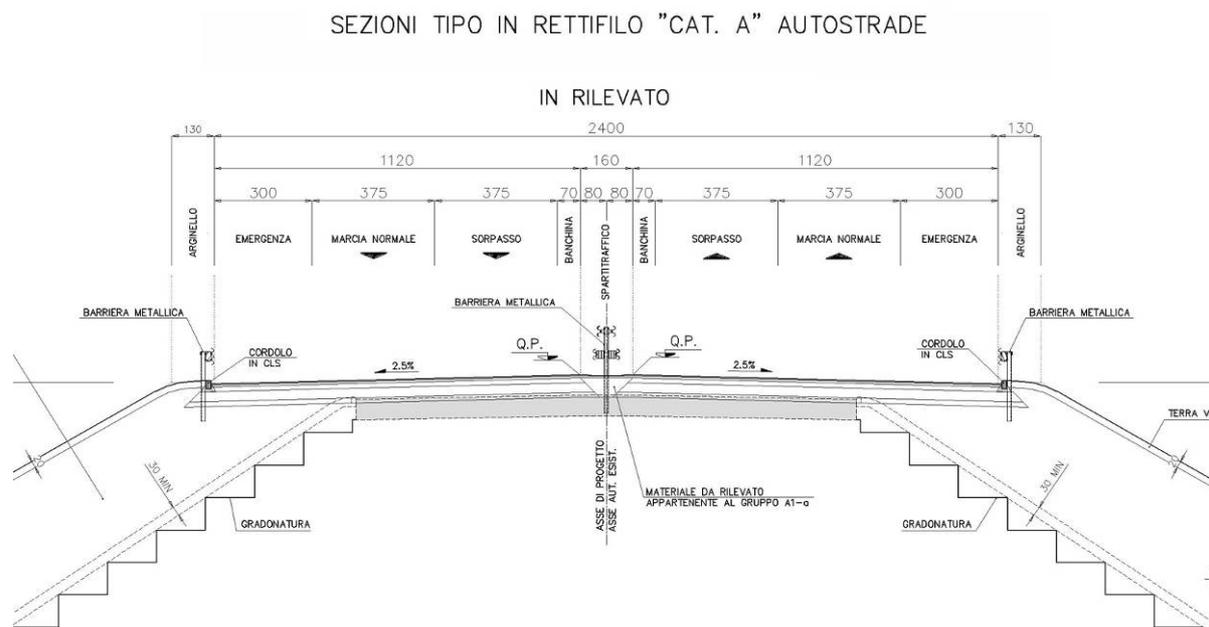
Sezione tipo di progetto (adeguamento simmetrico Variante SS1 Aurelia)
